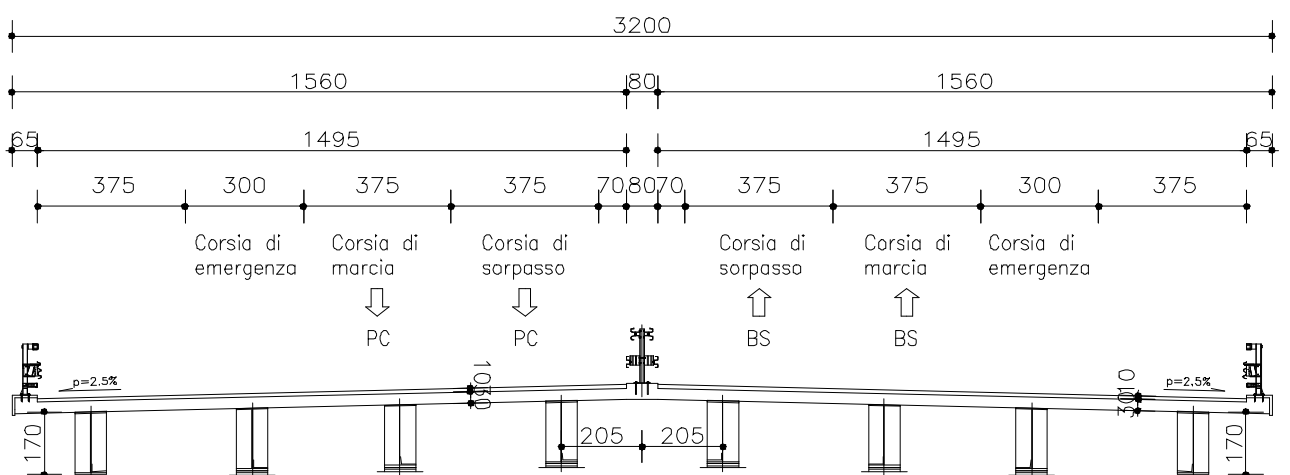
Sezione trasversale dell'impalcato in corrispondenza delle pile P01÷P24-P37÷P40
